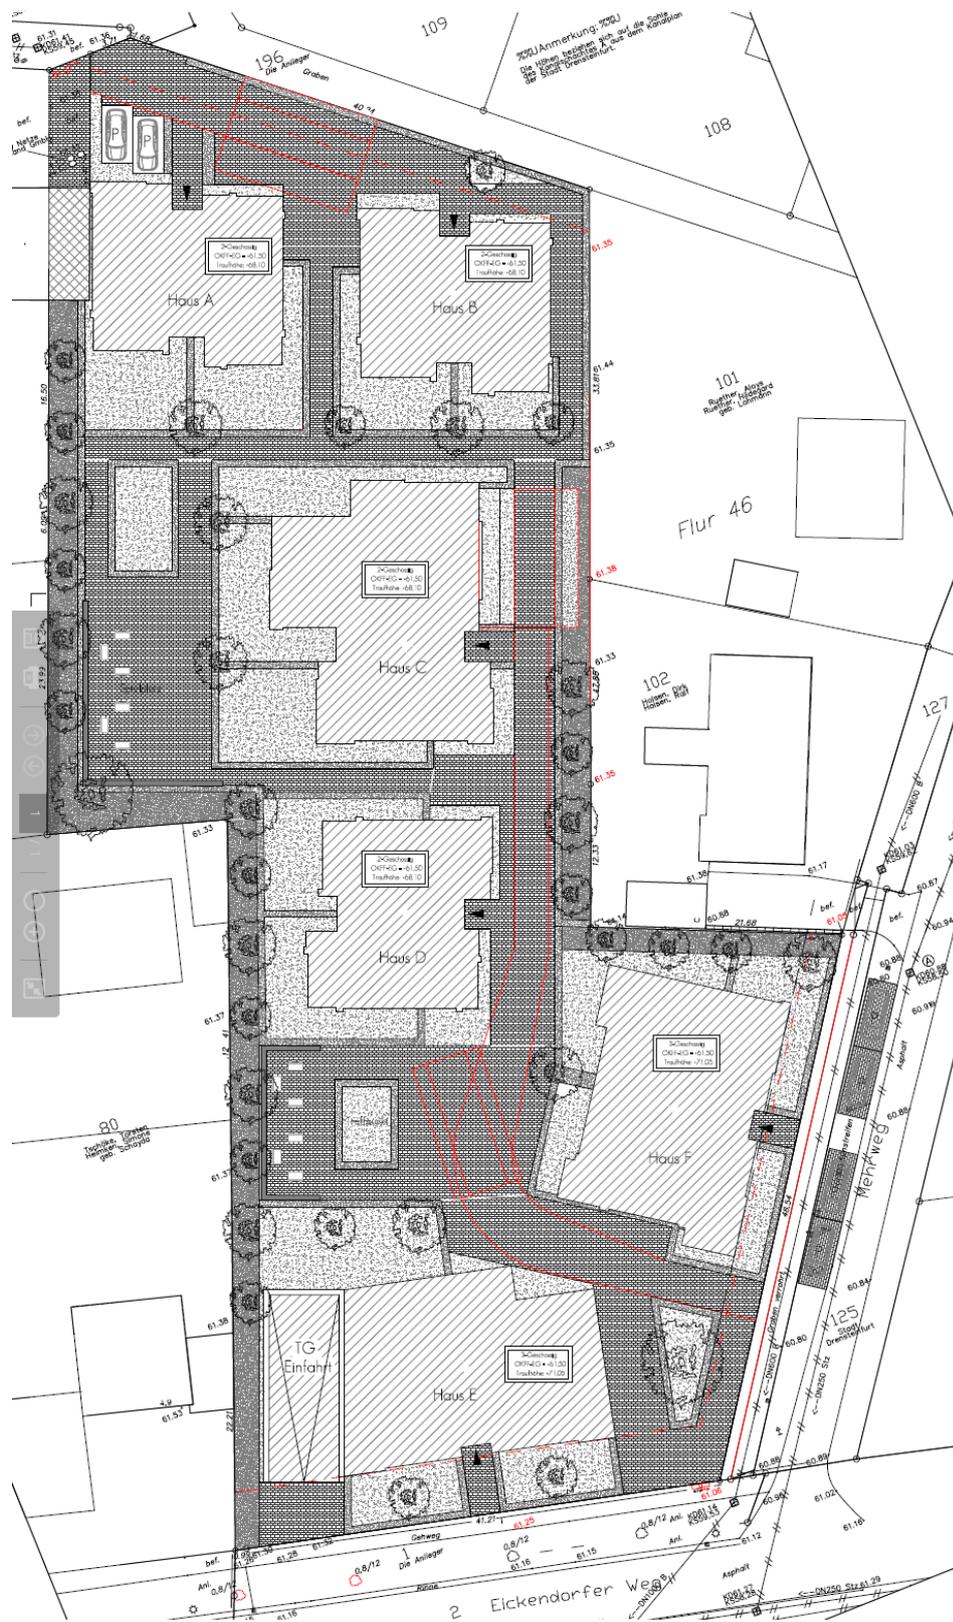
Ausschnitt aus dem Lageplan des Bauvorhabens (Architekturbüro Heitfeld)
